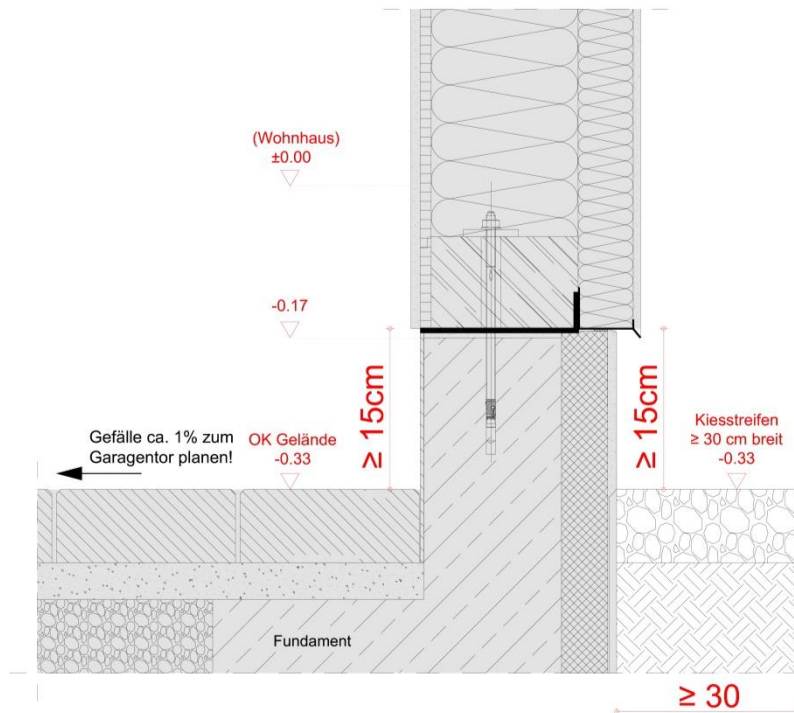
LUXHAUS Sockeldetail 14 - LUXHAUS Garage mit Betonaukantung
